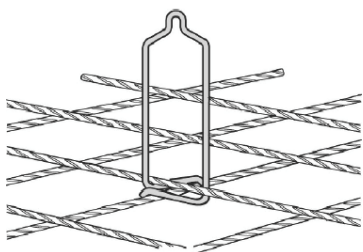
Unter gleichzeitigem Zusammendrücken der Schenkel mit Rechtsdrehung auf unteren Bewehrungsstab einschnappen lassen.
